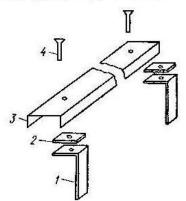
Опорный каркас для крепления металлопокрытия: 1— лапка, 2— асбокартон, 3— планка, 4— заклепка
